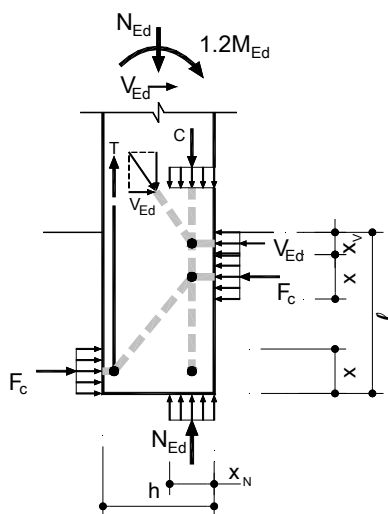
Ligação pilar-fundação em cálice - modelo simplificado para o cálculo da profundidade do cálice.
